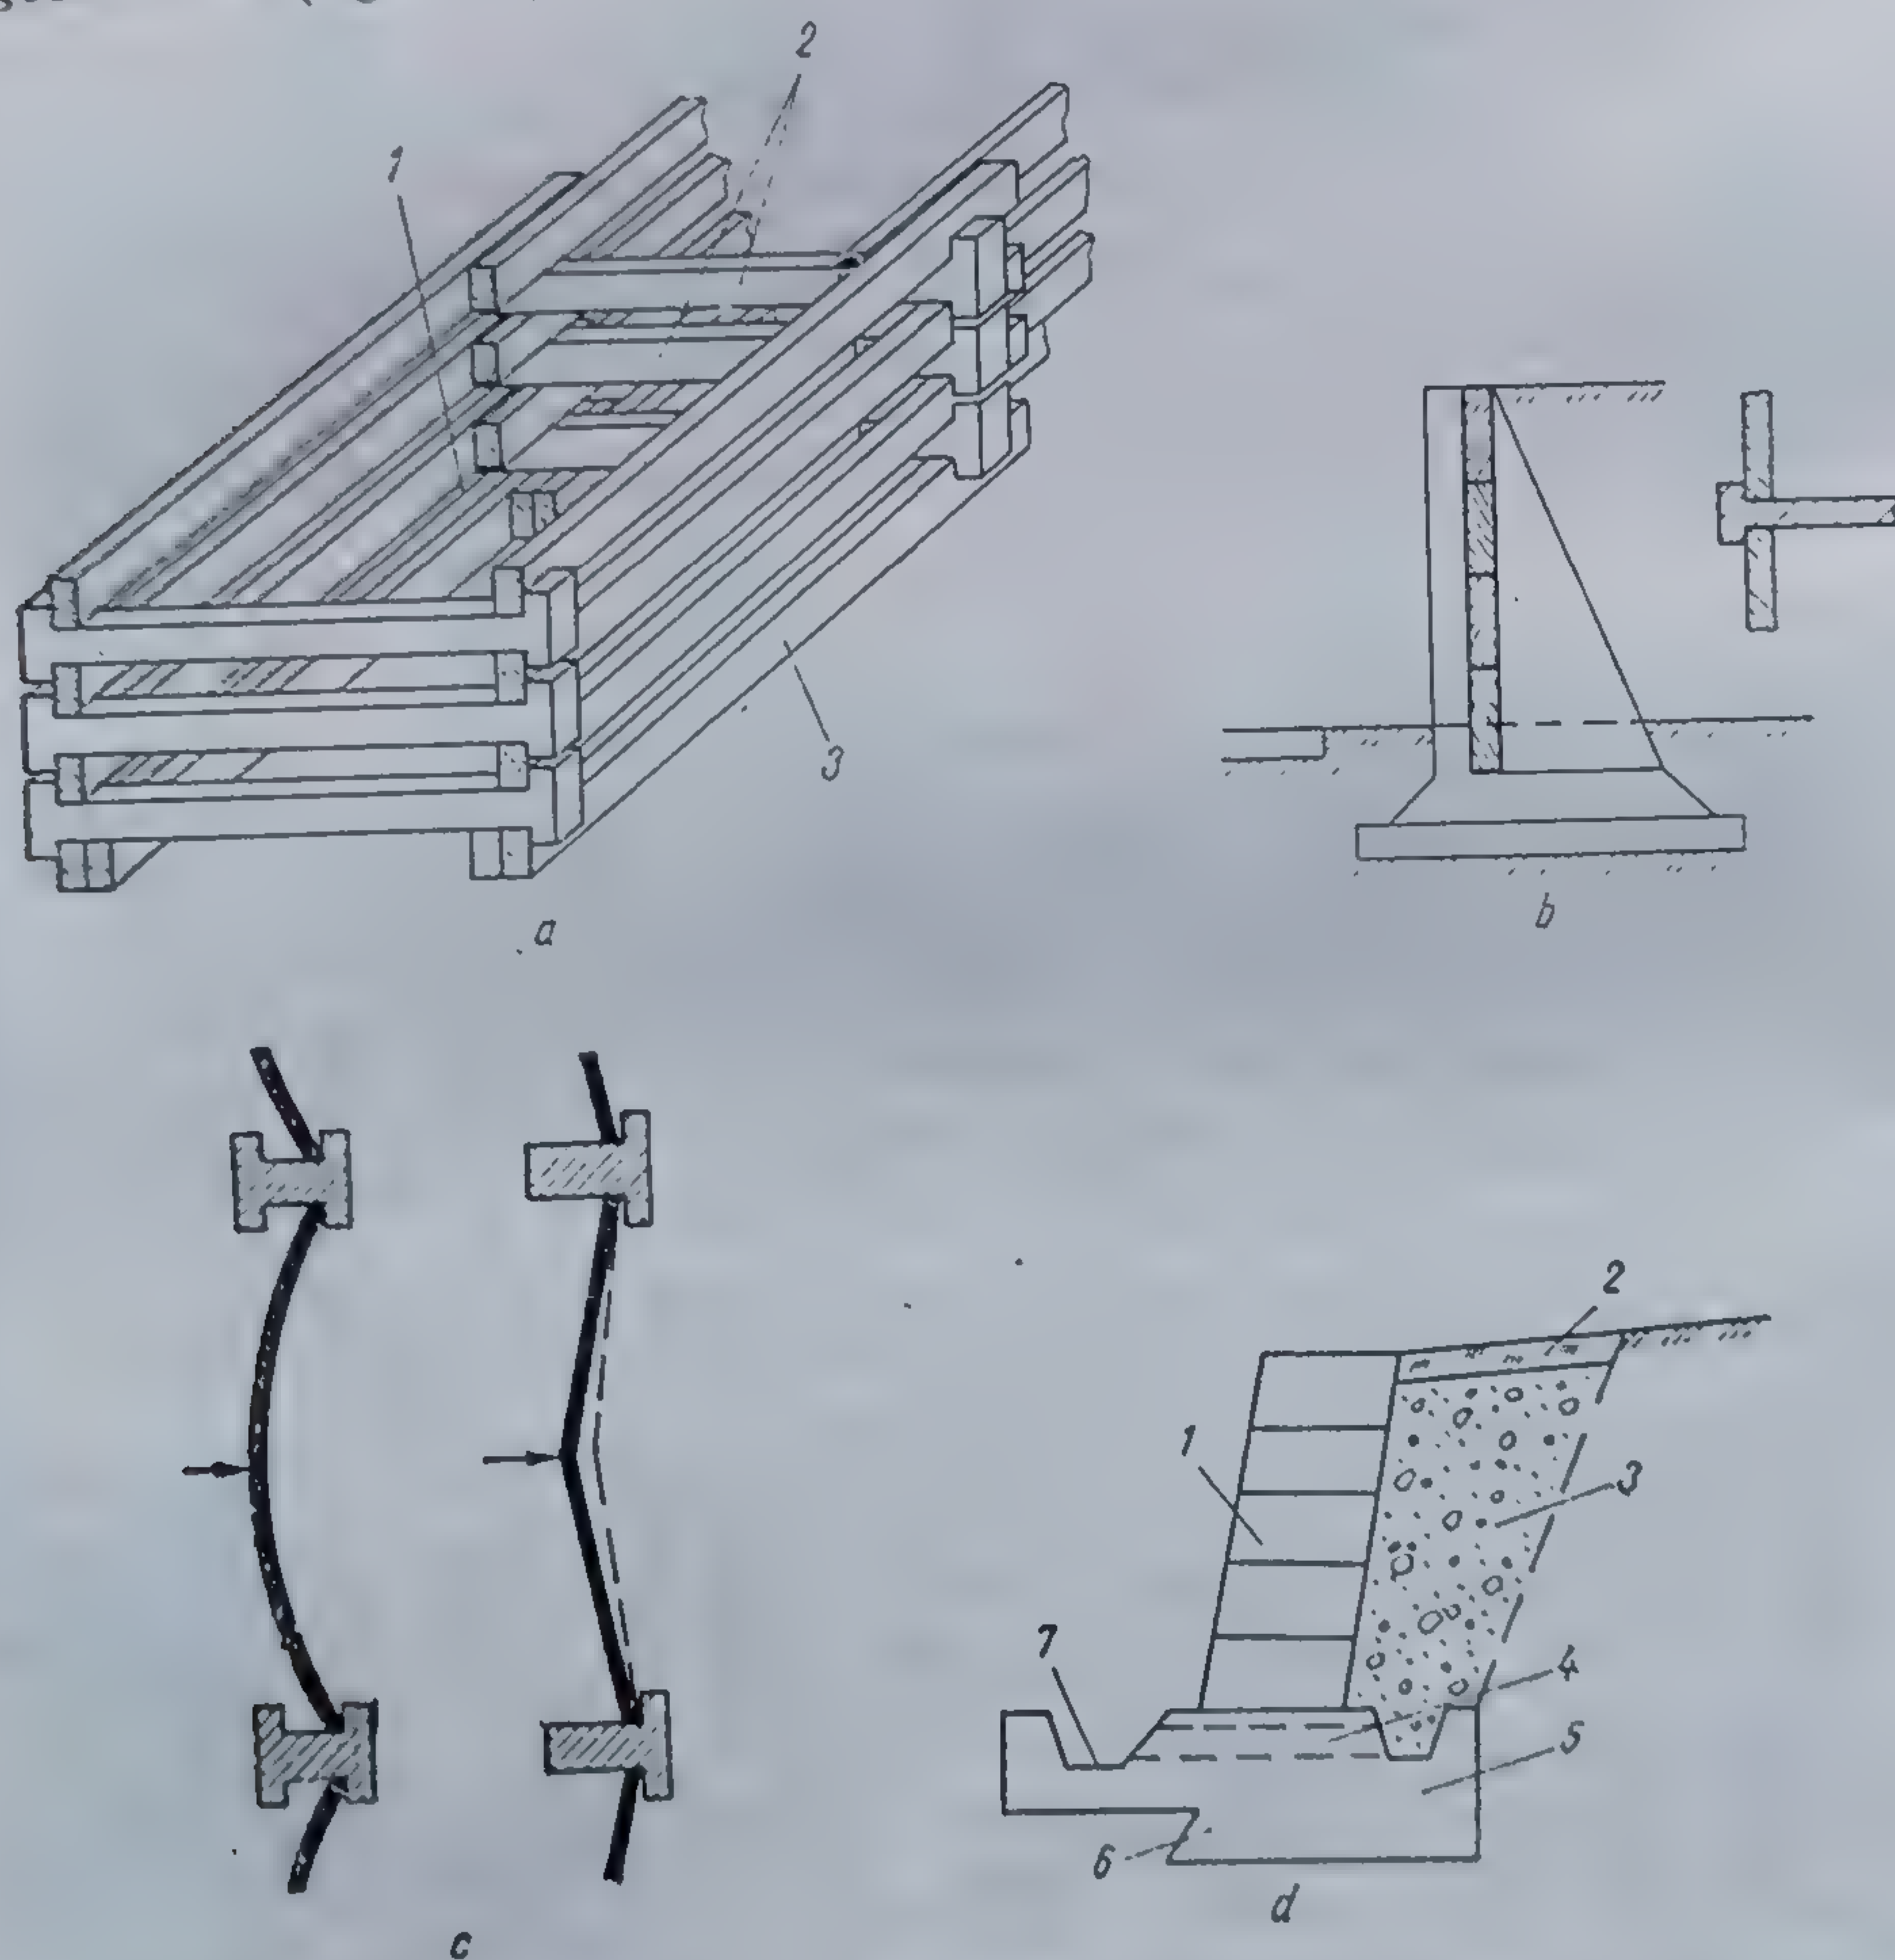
Ziduri de sprijin din elemente prefabricate de beton armat :
